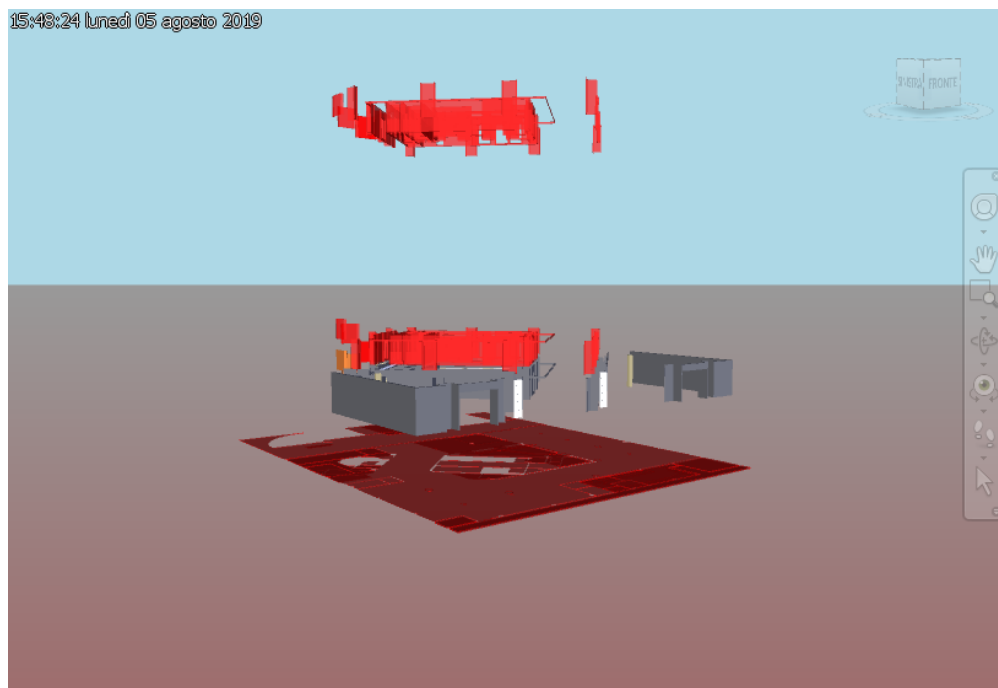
Simulazione 4D - Elevazione Pavimenti S1 ed elevazione Muri P2, P9 (Navisworks)
